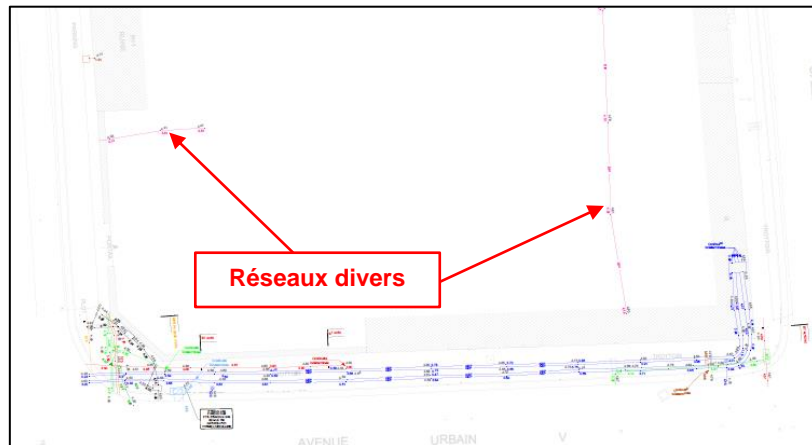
Extrait du plan de détection - exemples de réseaux divers positionnés en classe A.
